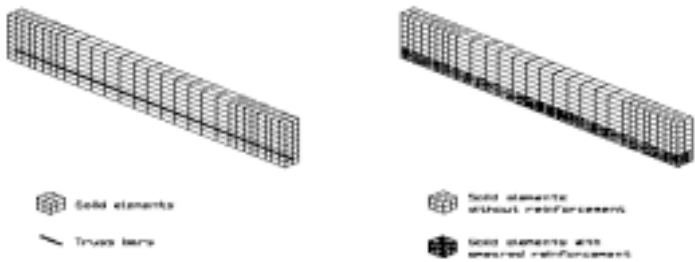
混凝土 Solid65 单元中的离散钢筋单元与弥散钢筋单元
